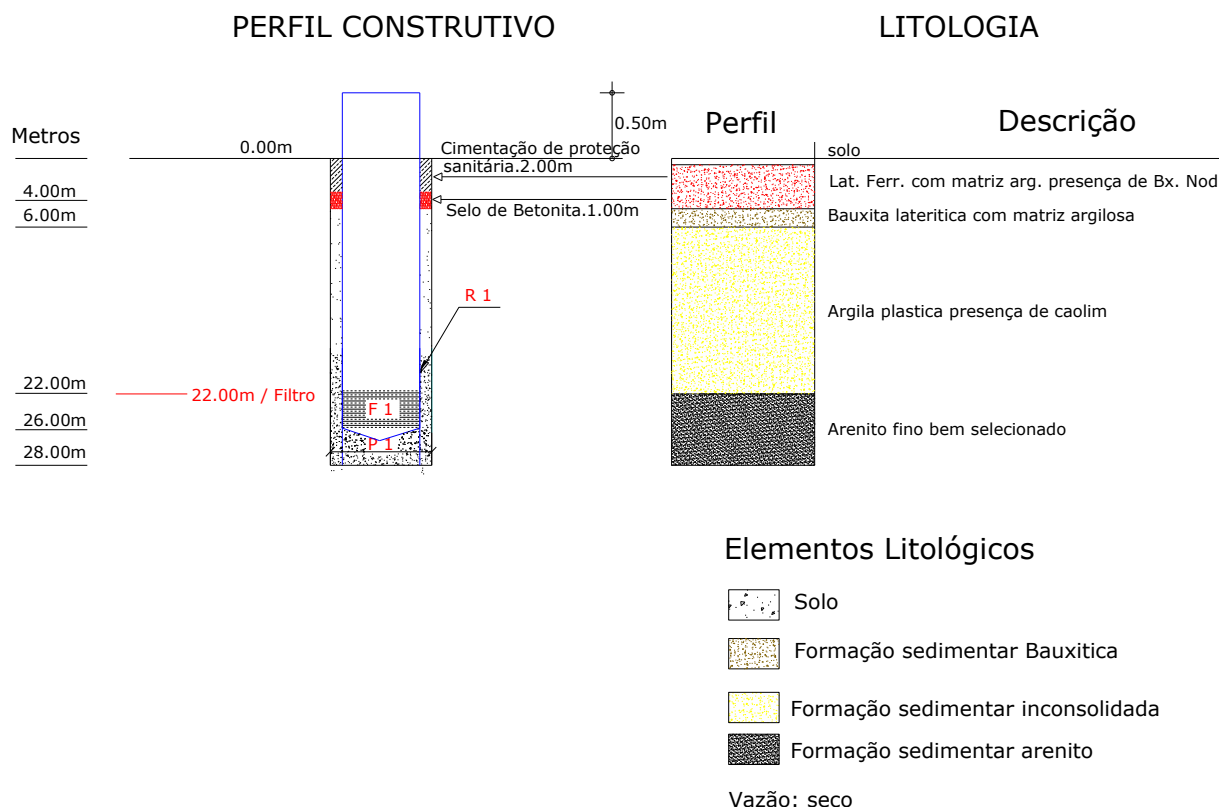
Perfil construtivo esquemático dos piezômetros rasos e em área reflorestada.
